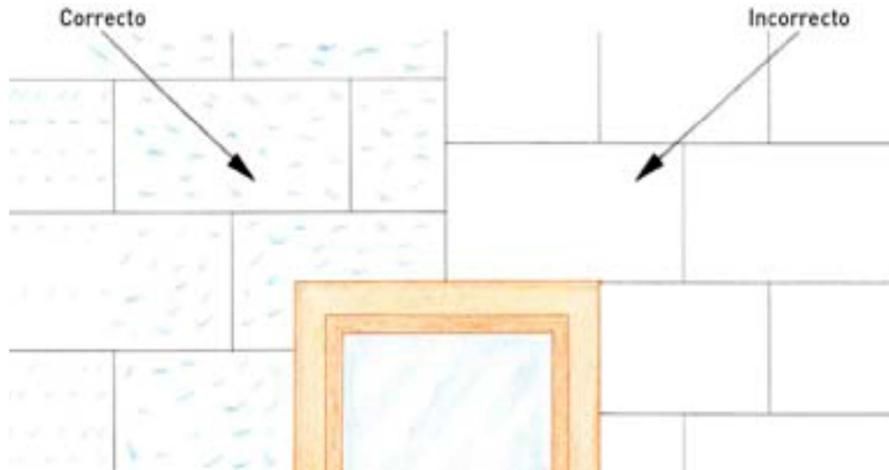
Instalación de los paneles de aislamiento en las esquinas de los huecos.
